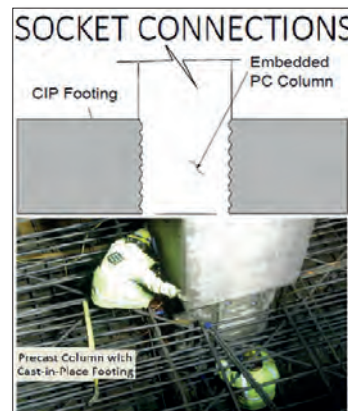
Ejemplos conexiones entre elementos prefabricados (PBES) d) Pocket.
